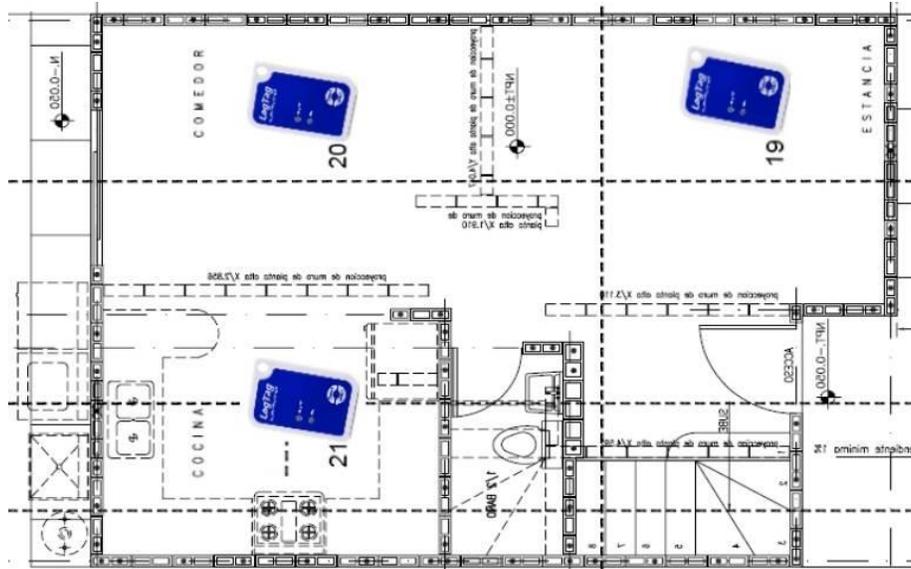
Planta arquitectónica de la vivienda cuatro, segundo nivel. Orientada al Norte.
